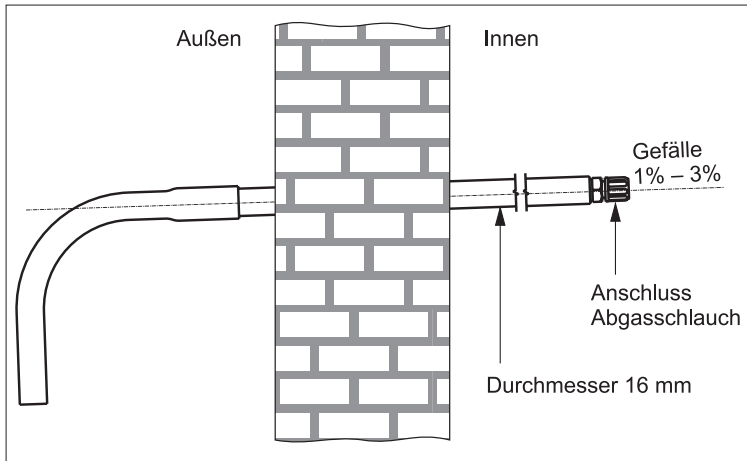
Wanddurchführung – Einbau in eine Außenmauer
